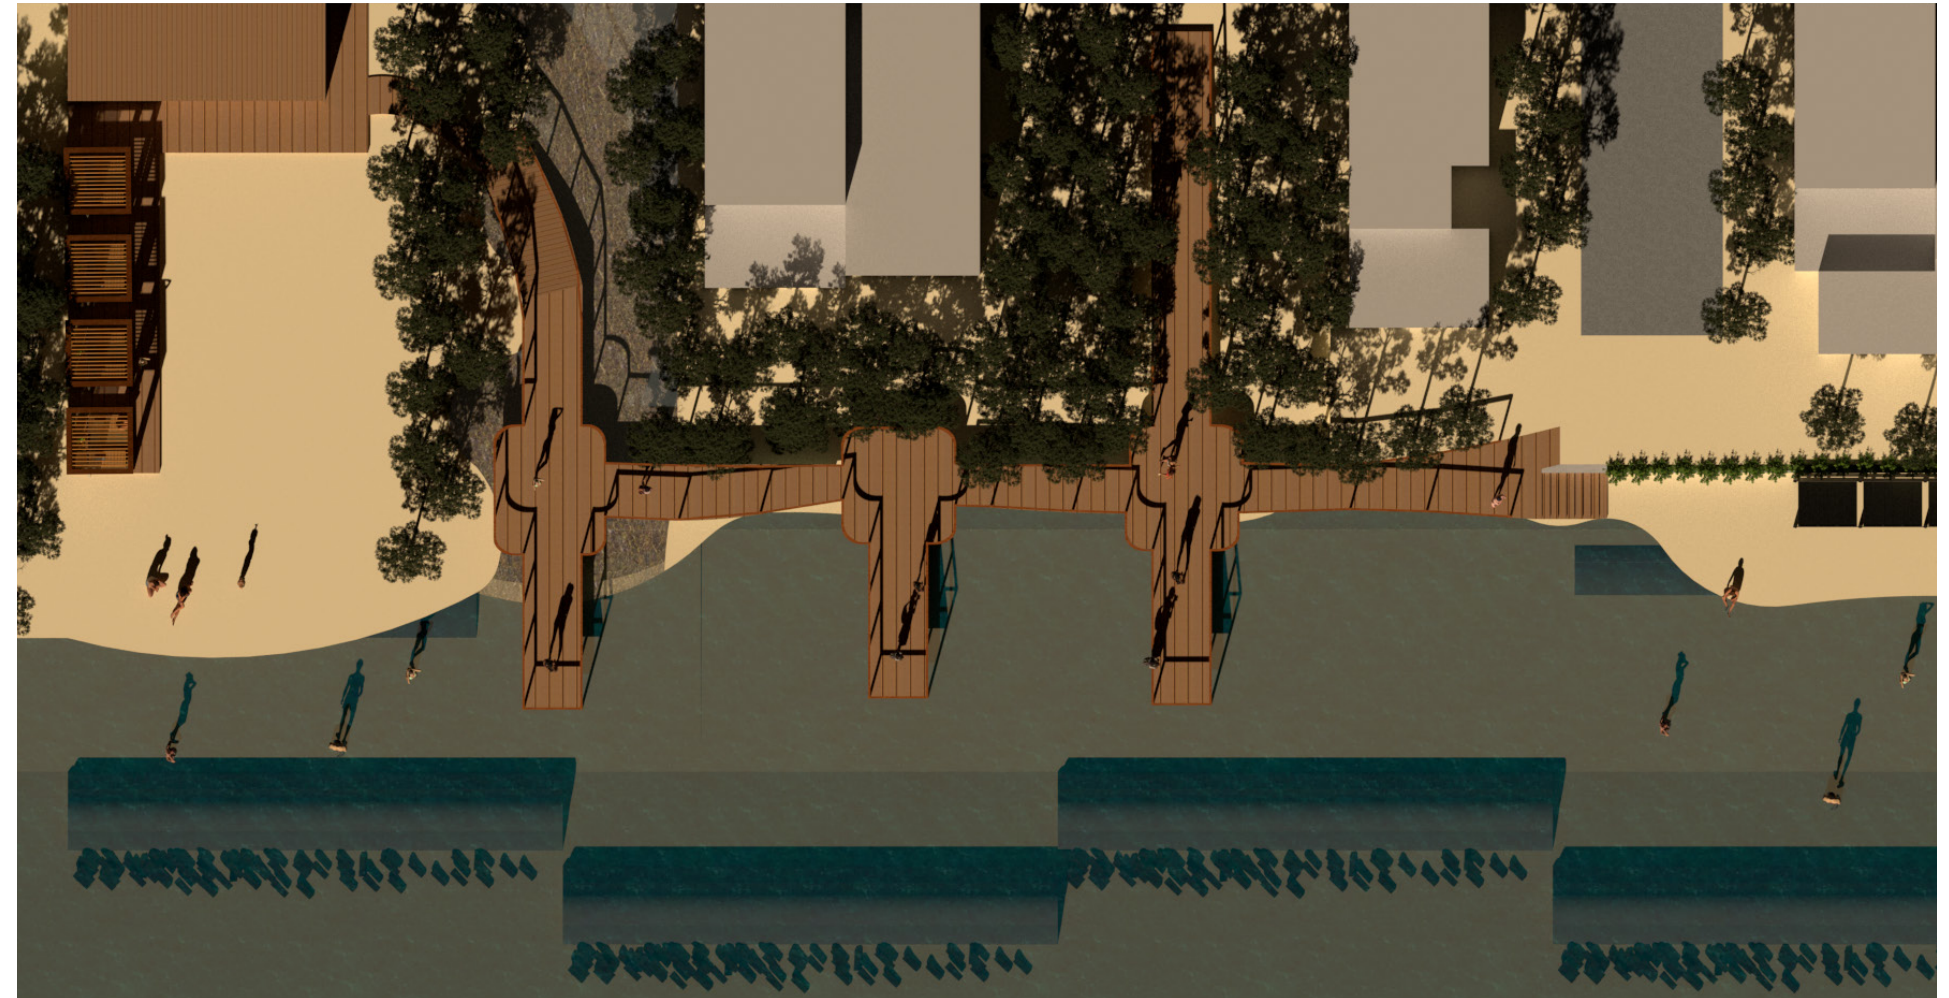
Planta de implantación de estrategias y restauración del espacio público. Autoría propia
